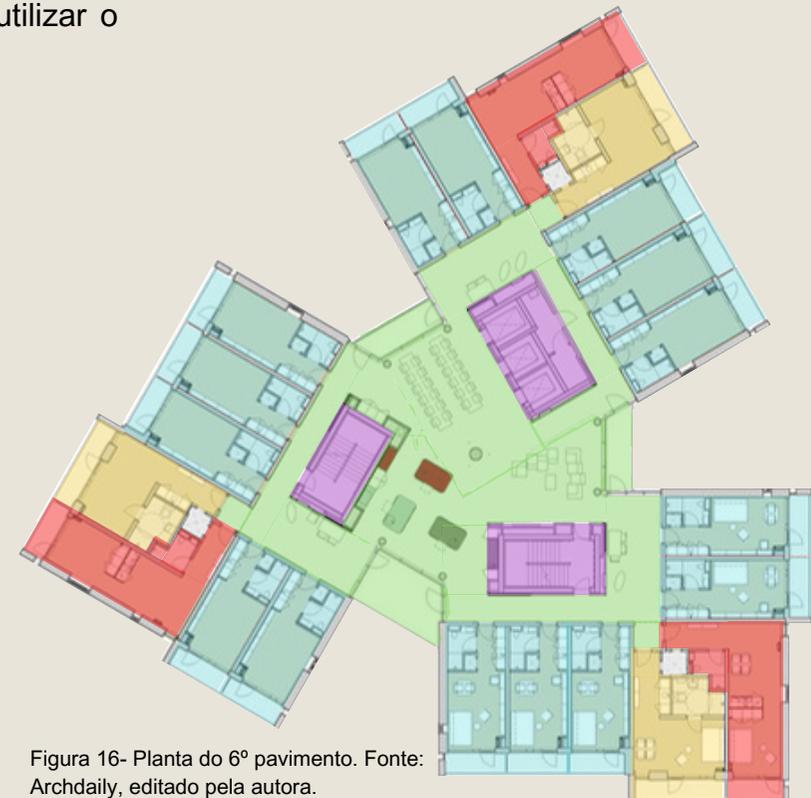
Planta do 6º pavimento. Fonte: Archdaily, editado pela autora.
